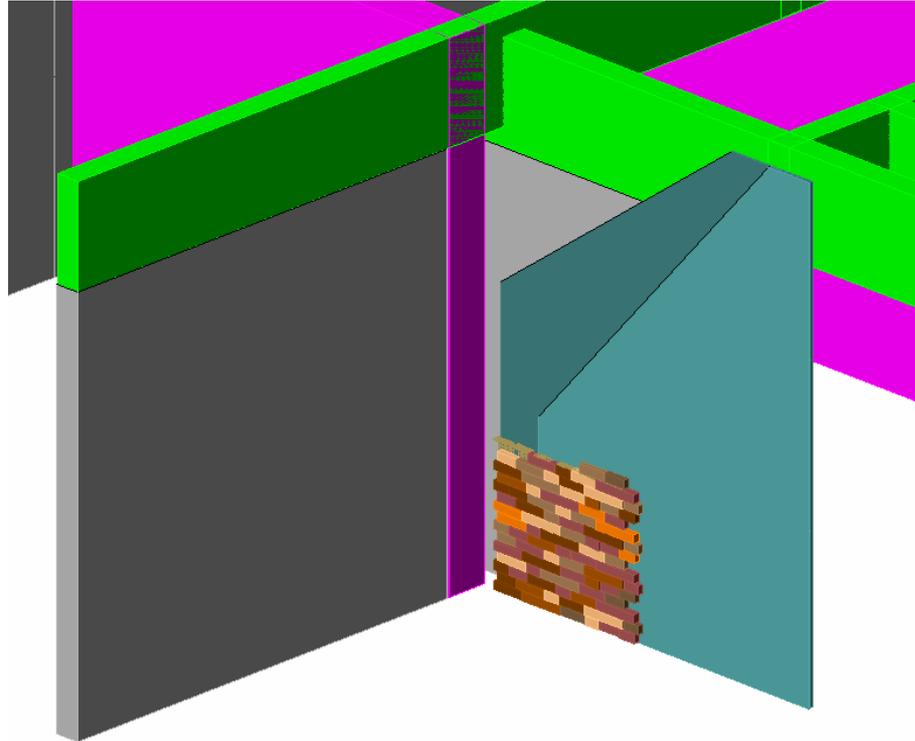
Vista geral das “paredes externas” (em cinza) e da estrutura (pilar em magenta e vigas em verde), com duas camadas de argamassa (regularização e fixação, em tons de azul) e o revestimento em filetes de pedra natural (“canjiquinhas”)
